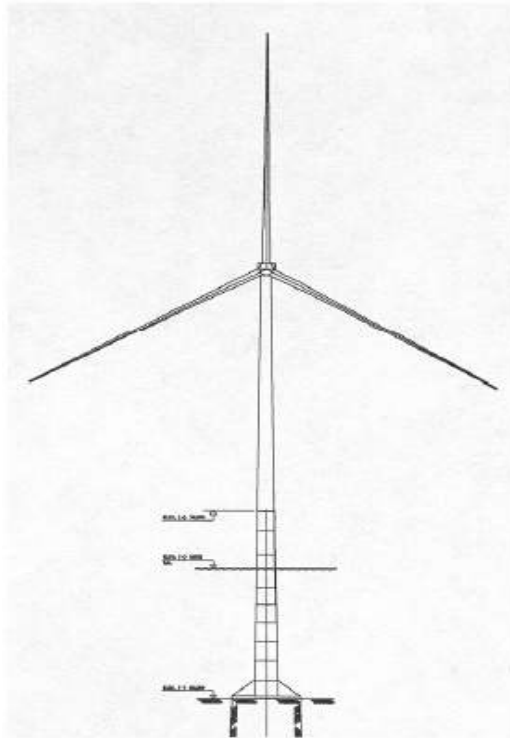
FUNDAÇÃO DO TIPO VÁCUO.
